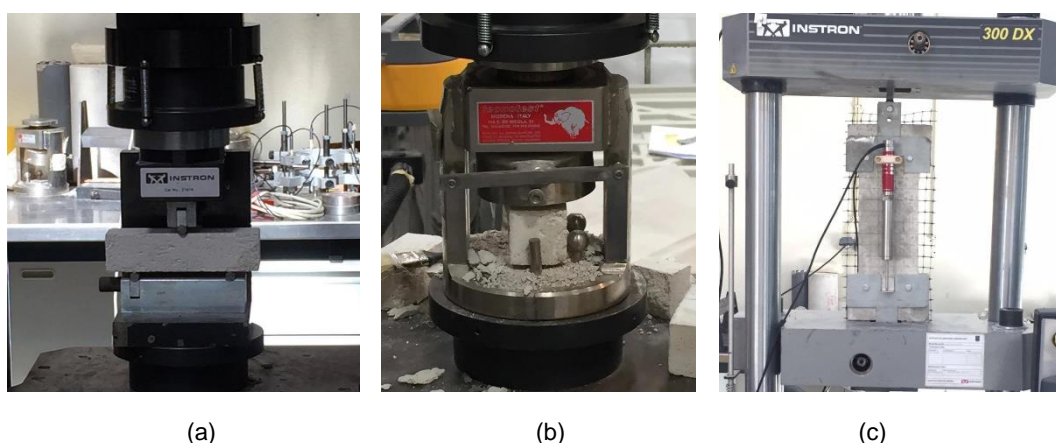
Ensaio dos provetes de argamassa utilizada na intervenção de reabilitação e reforço do murete de alvenaria de tijolo (30x20x11): (a) Ensaio à flexão de provete de argamassa; (b) Ensaio à compressão de provete de argamassa; (c) Ensaio à tração de provete de argamassa com rede geossintética embebida.
